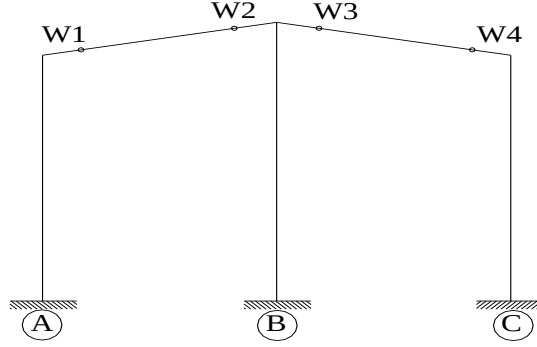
Prefabrik Endüstri Binası Sistem Planı
